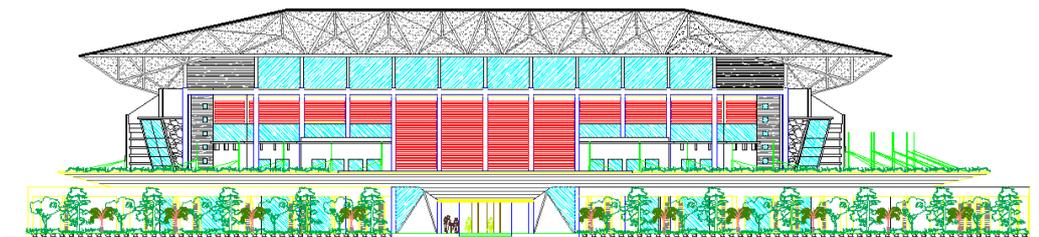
Alternatif 1 Tampak Depan Bangunan
